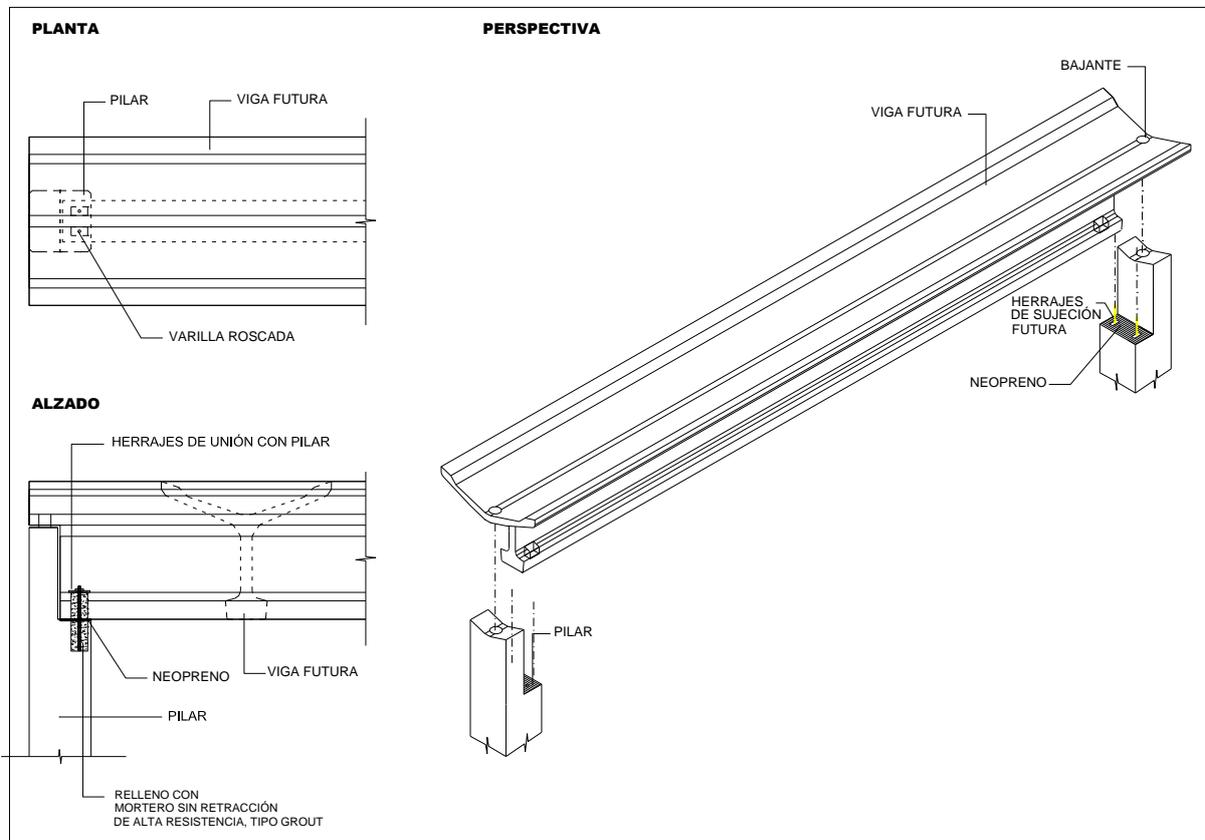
Unión pilar - viga FUTURA para zona sísmica
